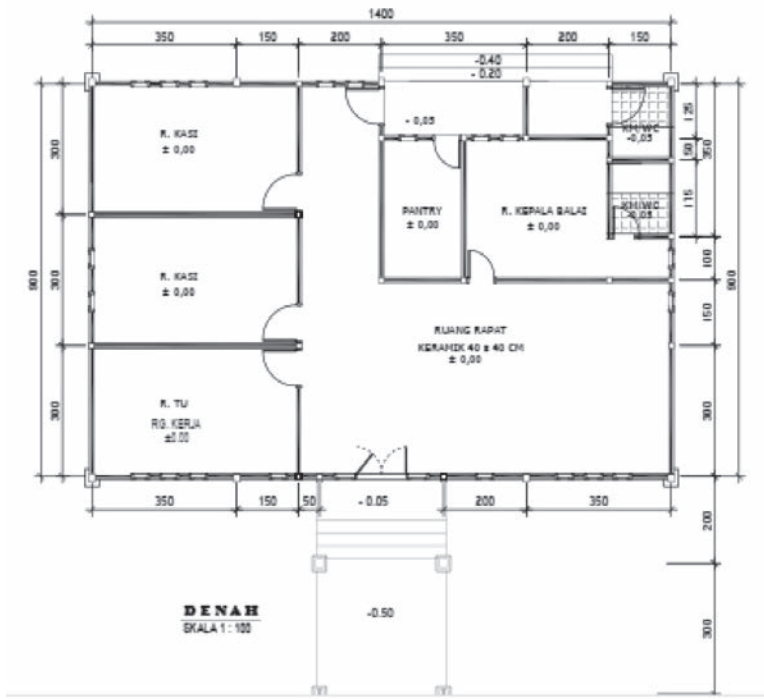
Pengembangan kawasan gedung BP3TR
